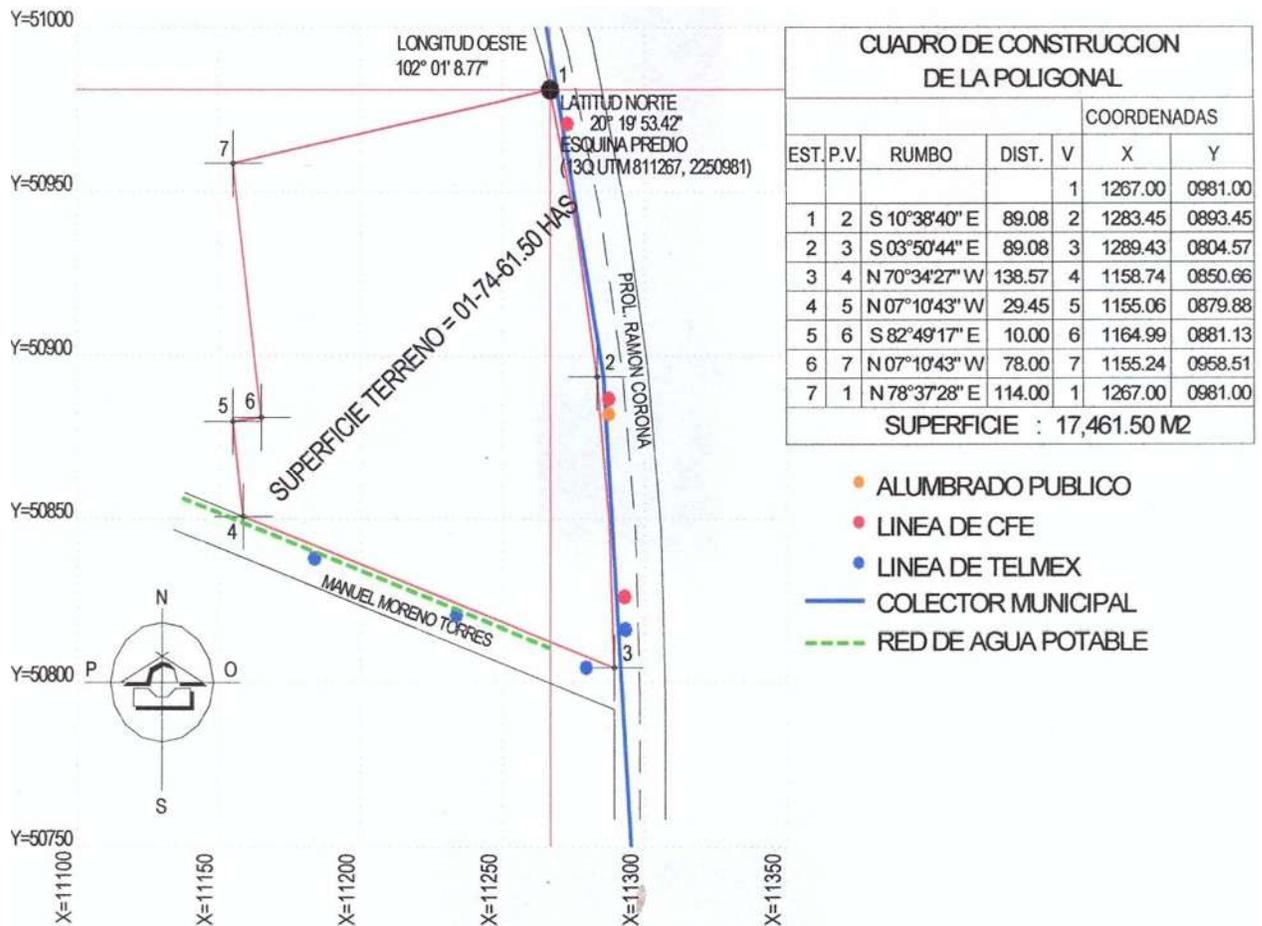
Croquis del levantamiento topográfico de la propuesta de terreno No. 2.
